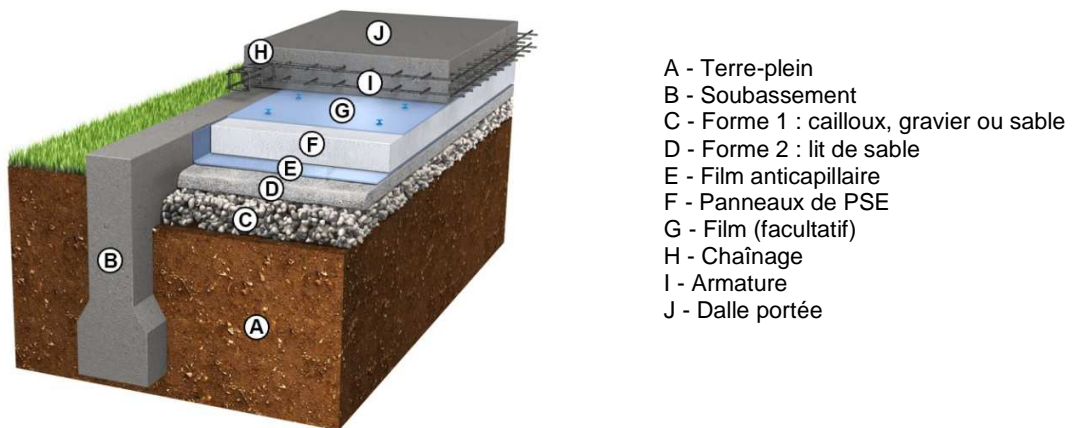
isolation en sous-face de dalle portée sur terre-plein
